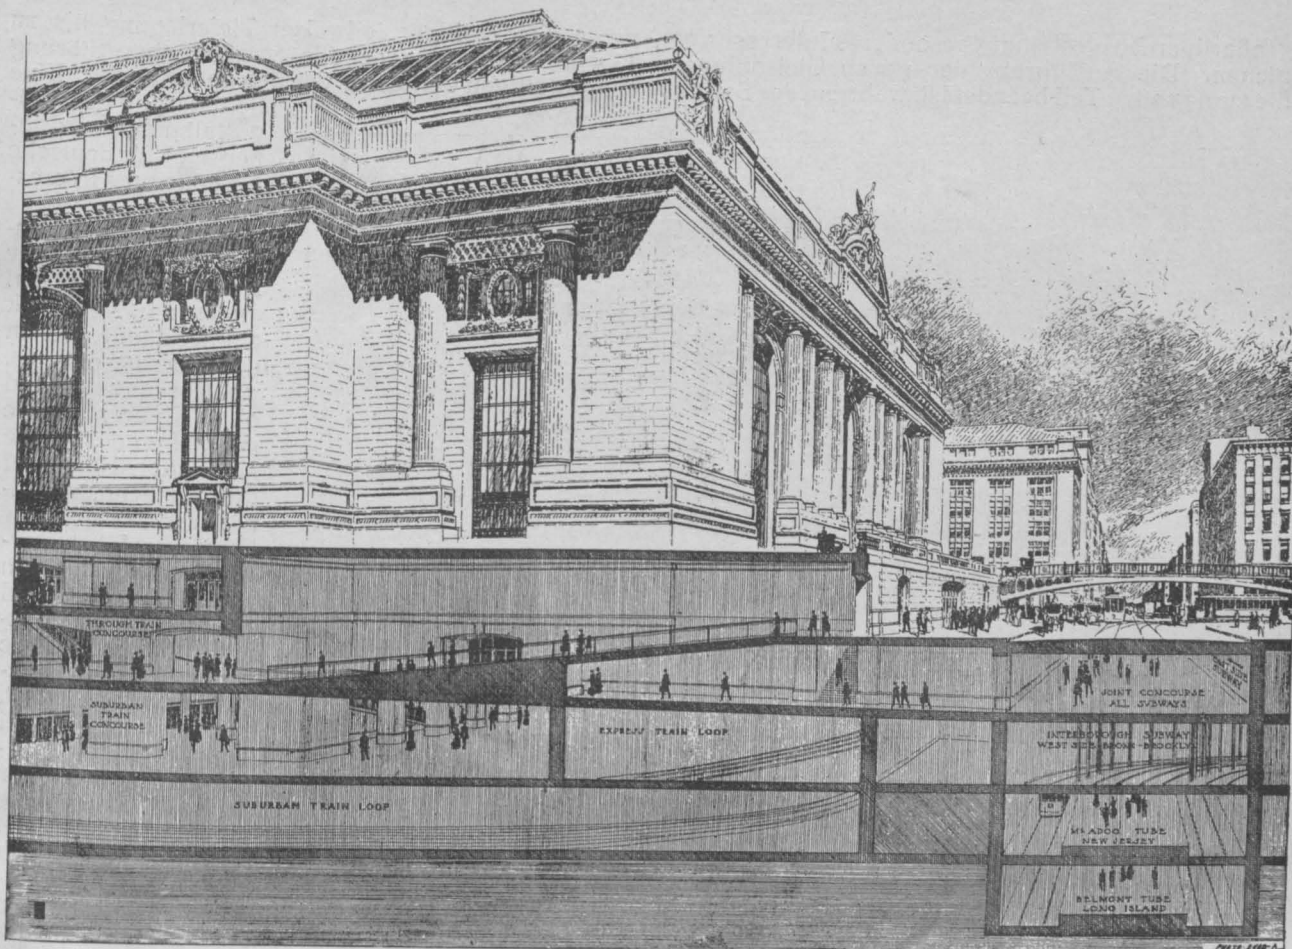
Empfangsgebäude Ecke 42. Straße und Vanderbilt Avenue. (Schnitt durch den Anschluß zu den Schnellbahnen.)
